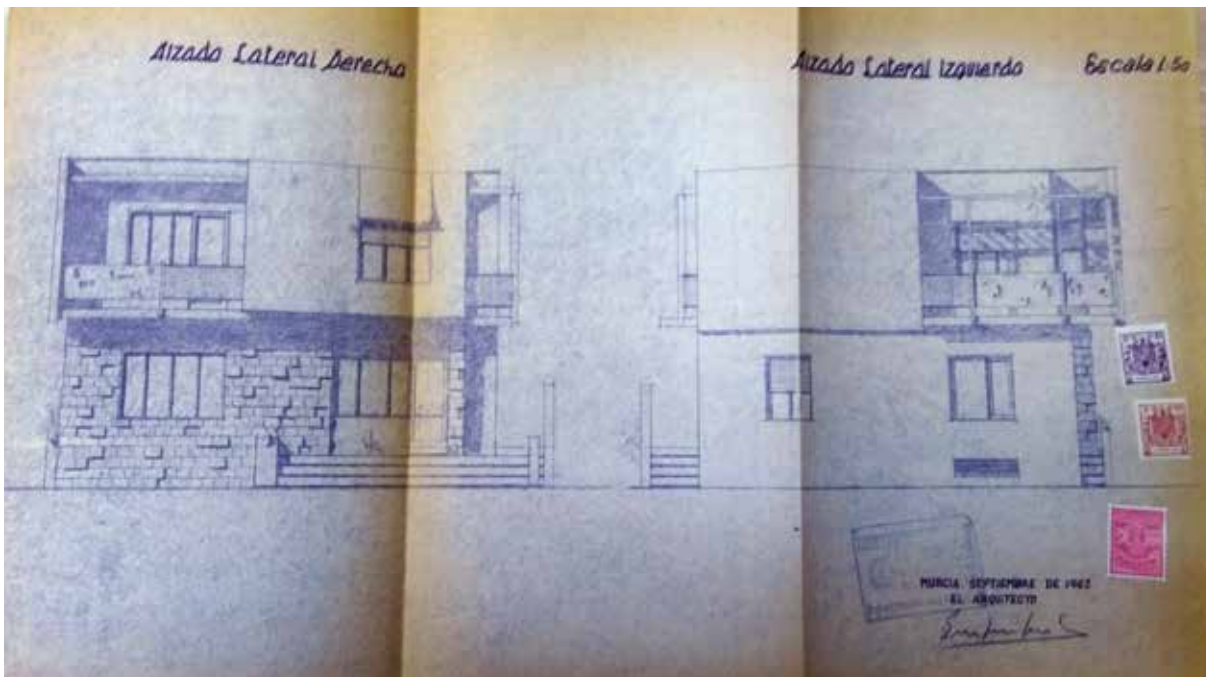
E. Sancho Ruano. Viviendas de Pedro Caro Romero. Alzado lateral. (Fuente: AML)
